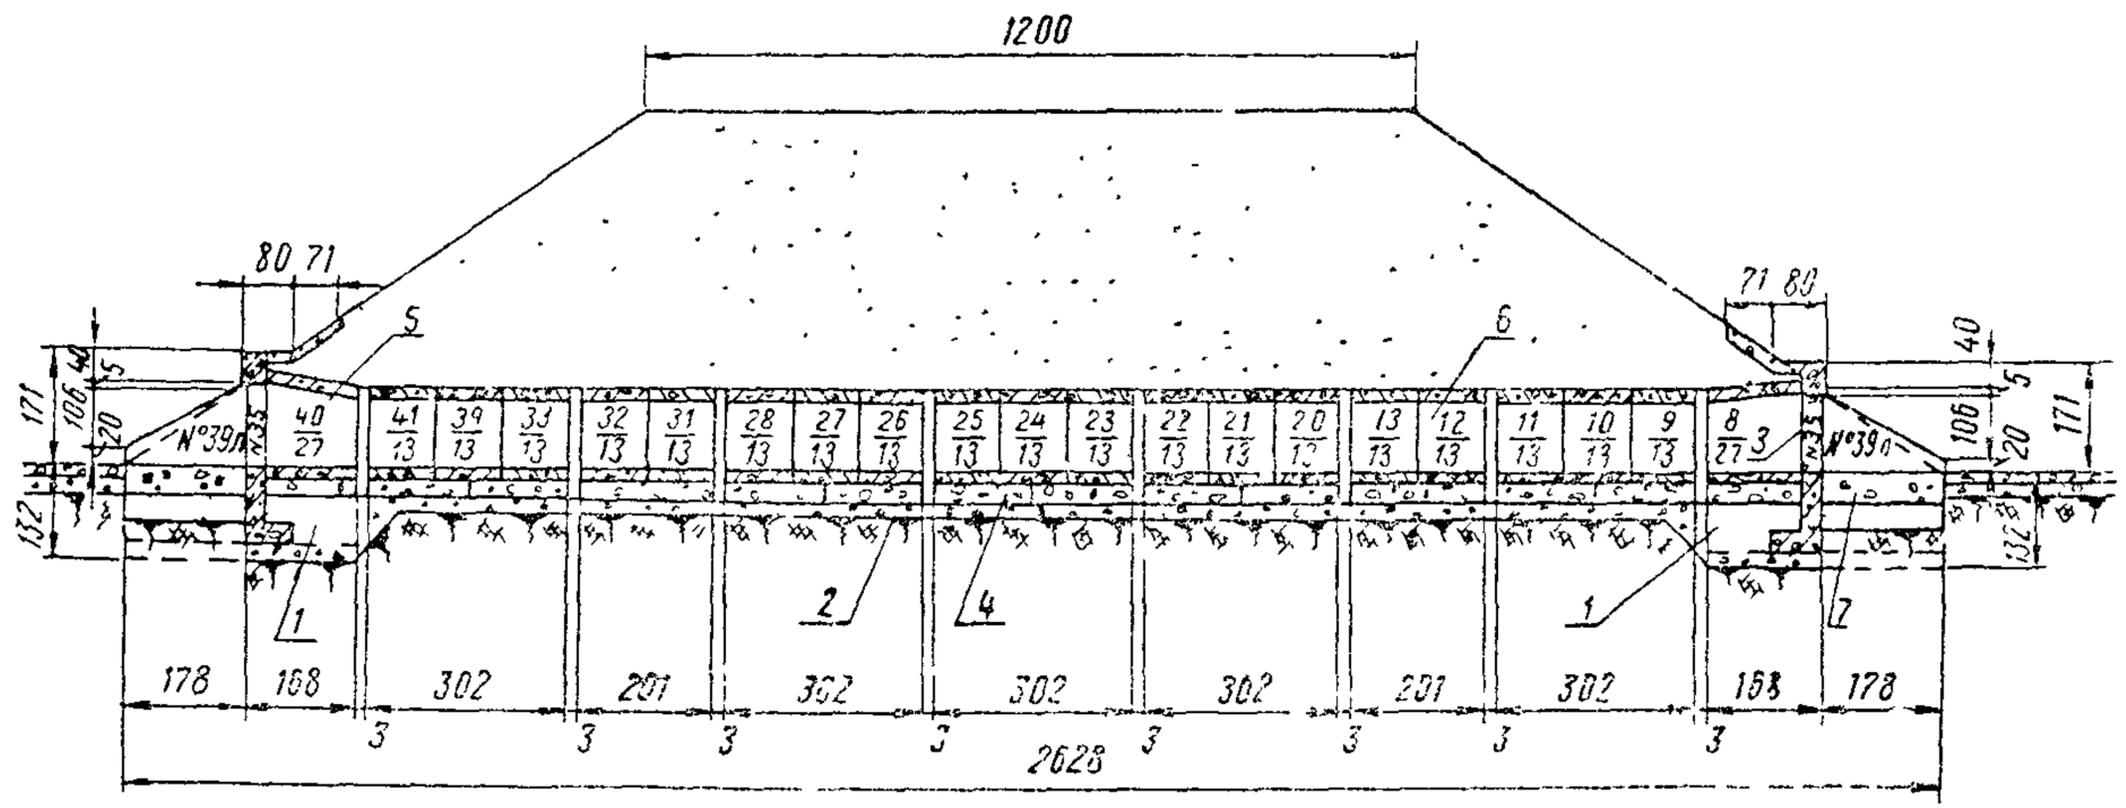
Конструкция и последовательность монтажа элементов трубы:
